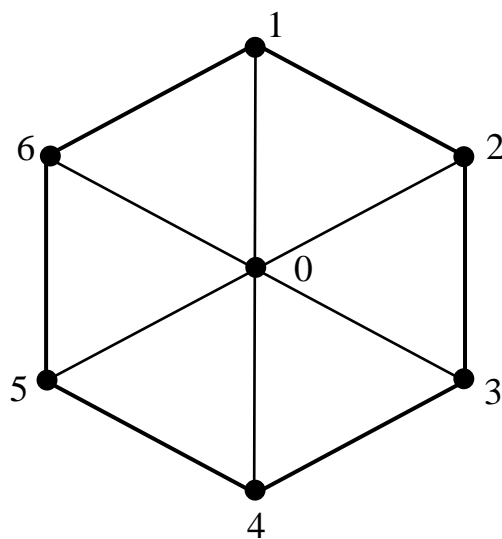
Планова геодезична основа для ковзної опалубки
